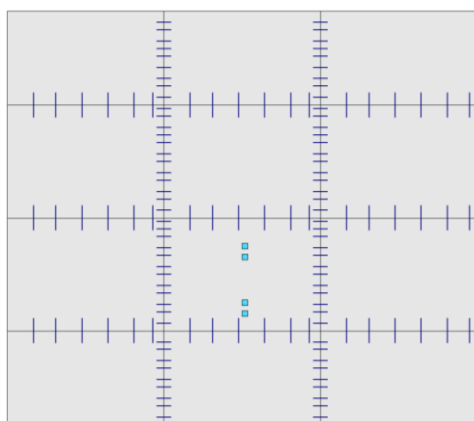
Estrutura de pavimento modelado com o ISLAB 2005
